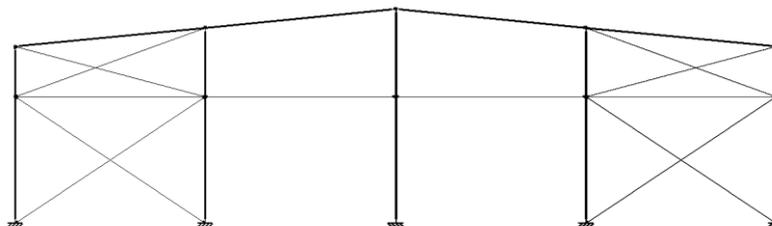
Vista del pórtico interior (Fuente: Cype3D)
